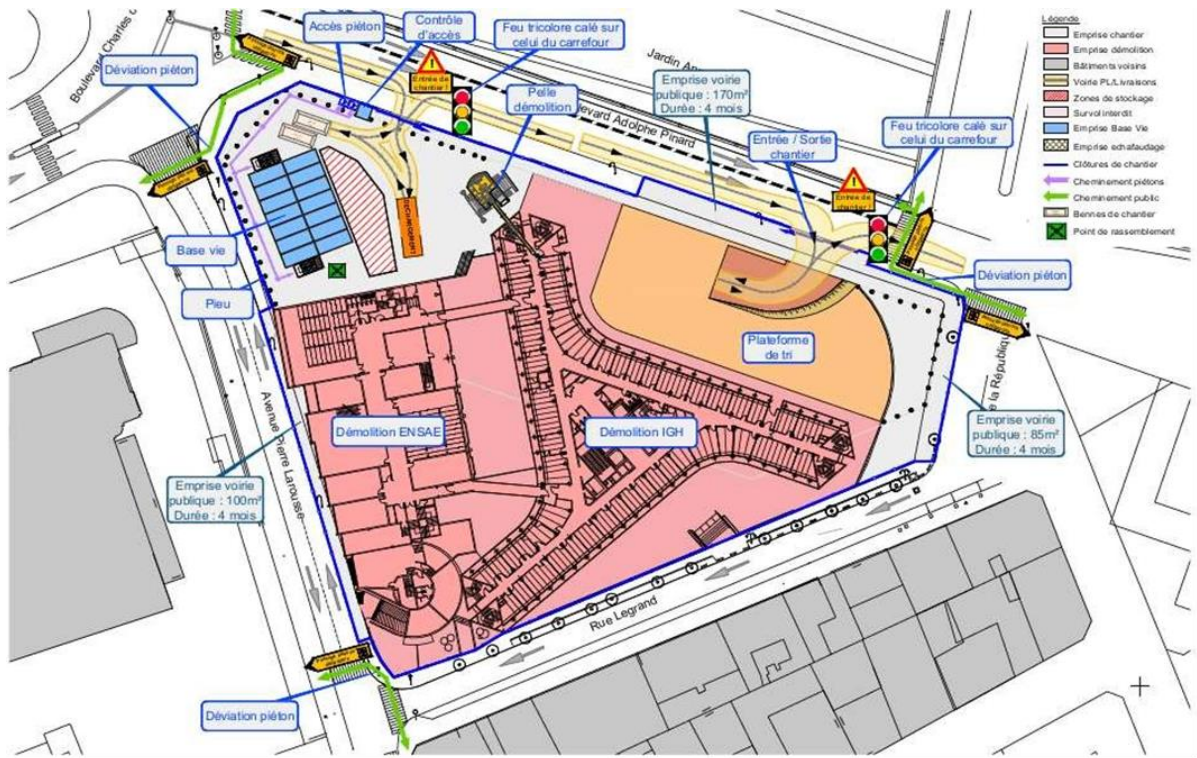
Plan d'Installation de chantier : phase déconstruction (Source : Eiffage, 2022)
